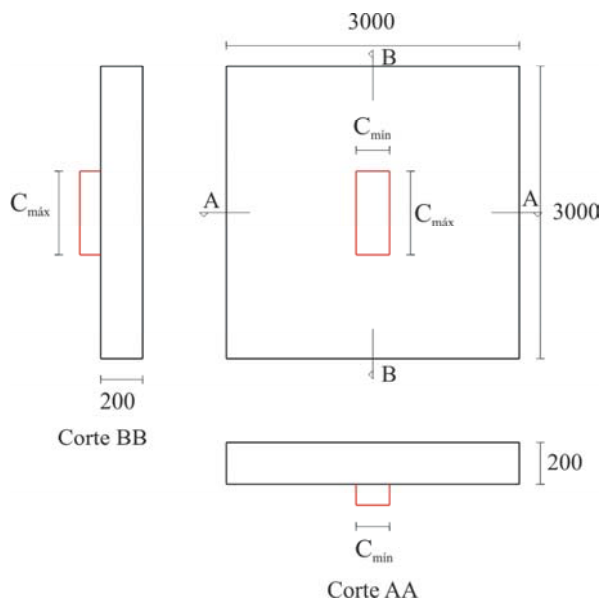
Sistema de ensaio utilizado por BORGES (2004) – (mm)
